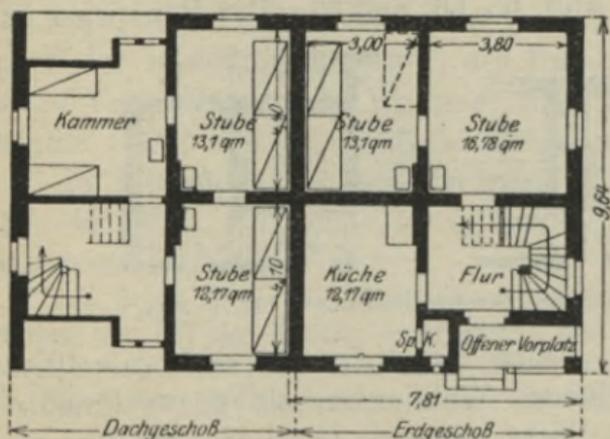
u. 67 a u. b. Einfamilien Doppelhaus für mittlere Beamte. Grundriß M. 1 : 300 und Ansichten M. 1 : 385.
